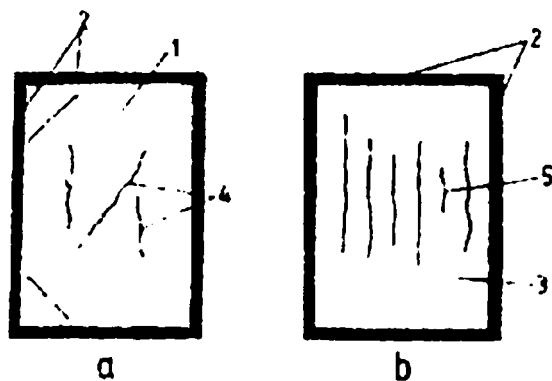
Fisuri ale plăcilor din beton armat ; a) fisuri la plăci monolite ;
